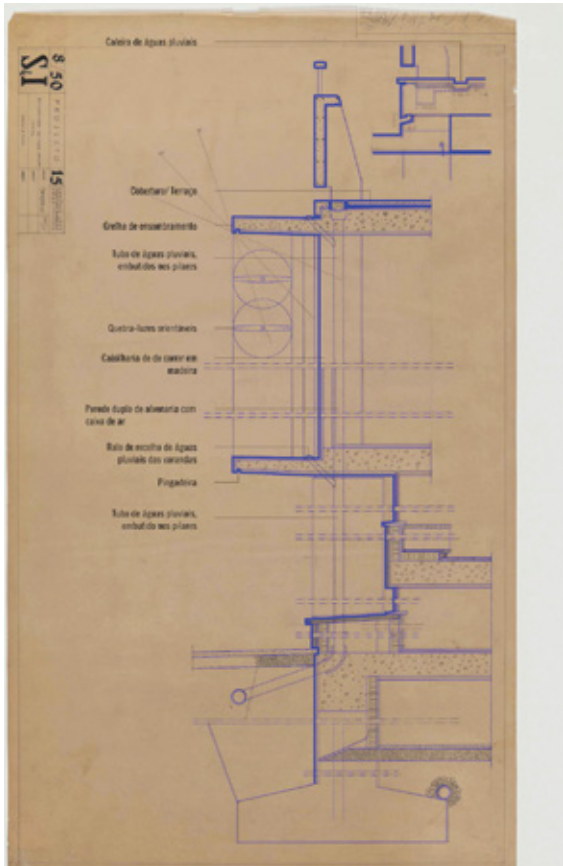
Redesenho sobre corte de fachada original do edifício Vouga/Soares & Irmãos, 2018
